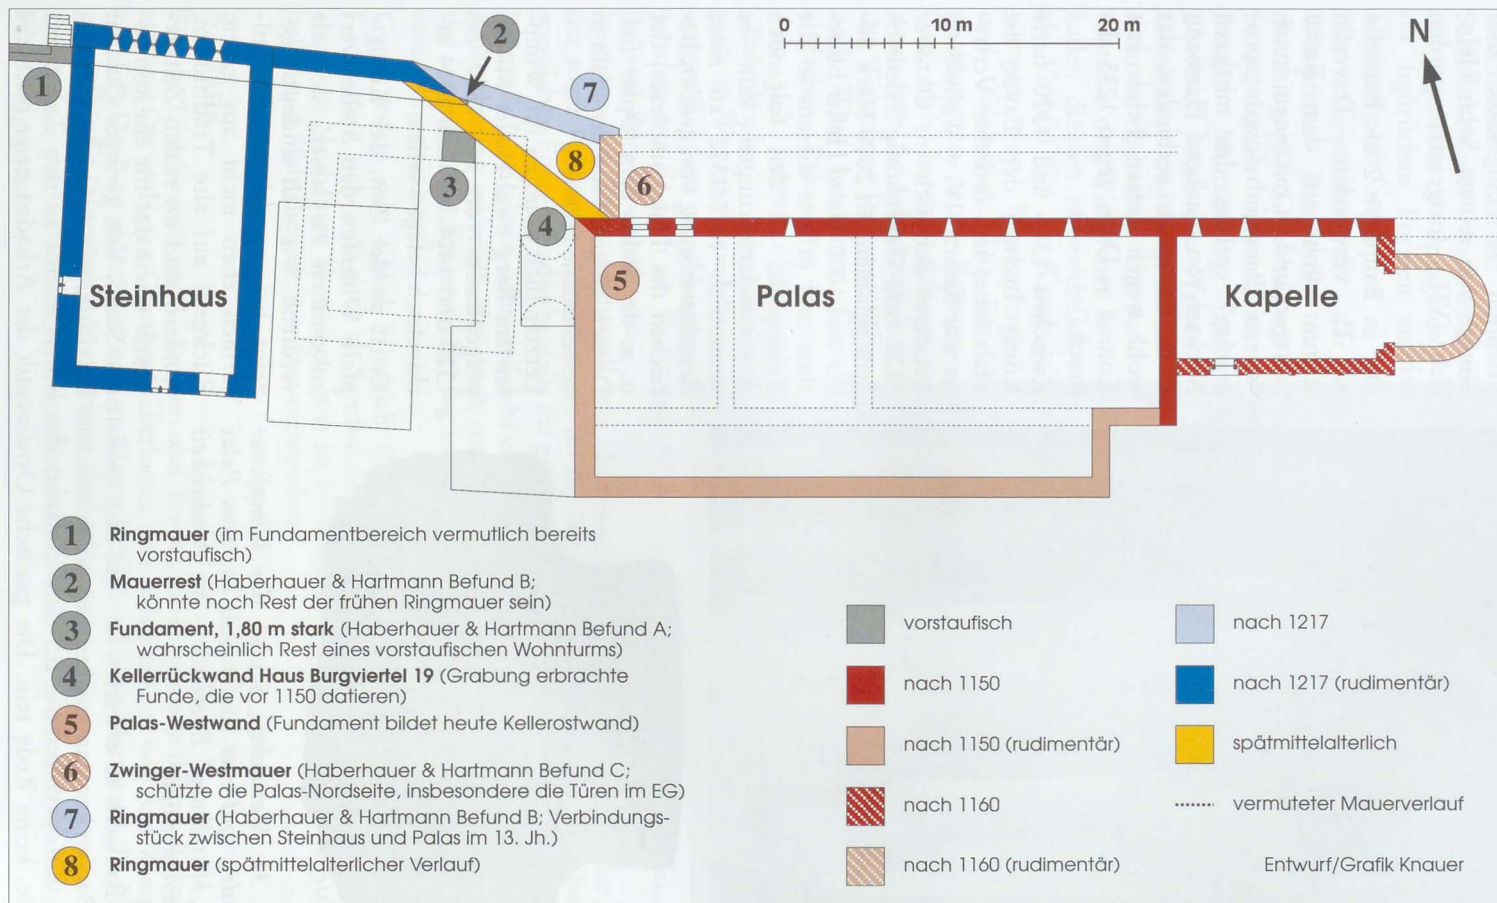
Grundriss von Steinhaus, Palas und Kapelle, mit Bauphasen
